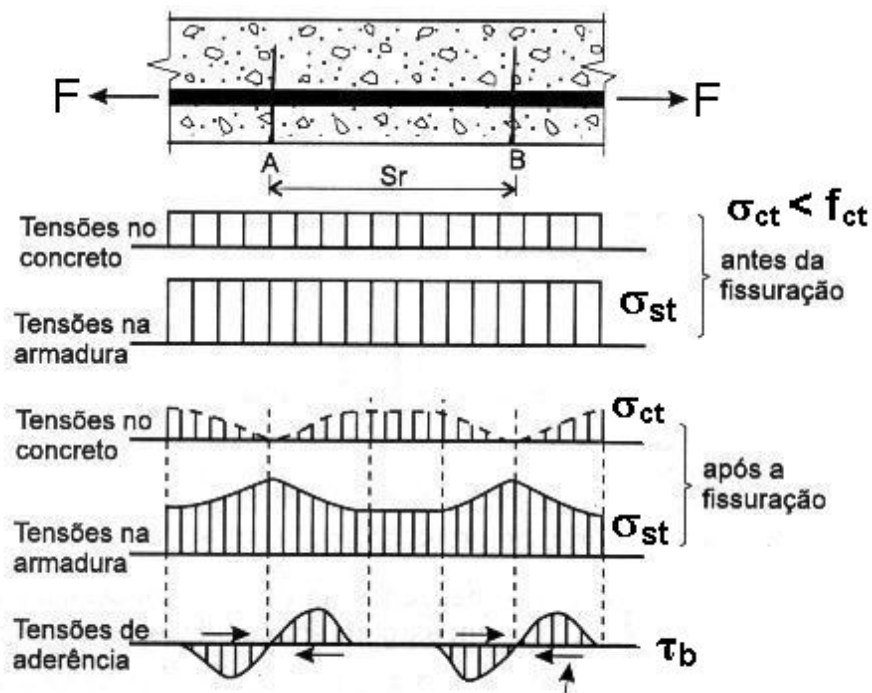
Fissuração por tração (FUSCO, 1995).
